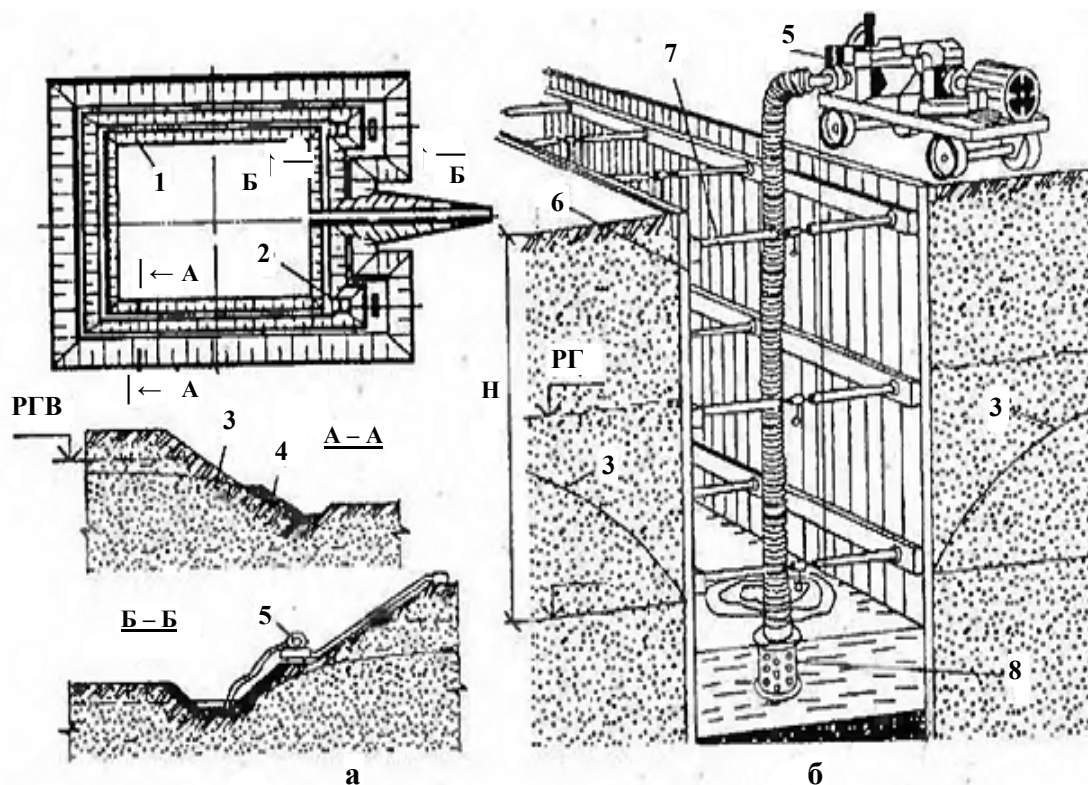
Відкритий водовідлив: а – із котловану; б – із траншеї;
